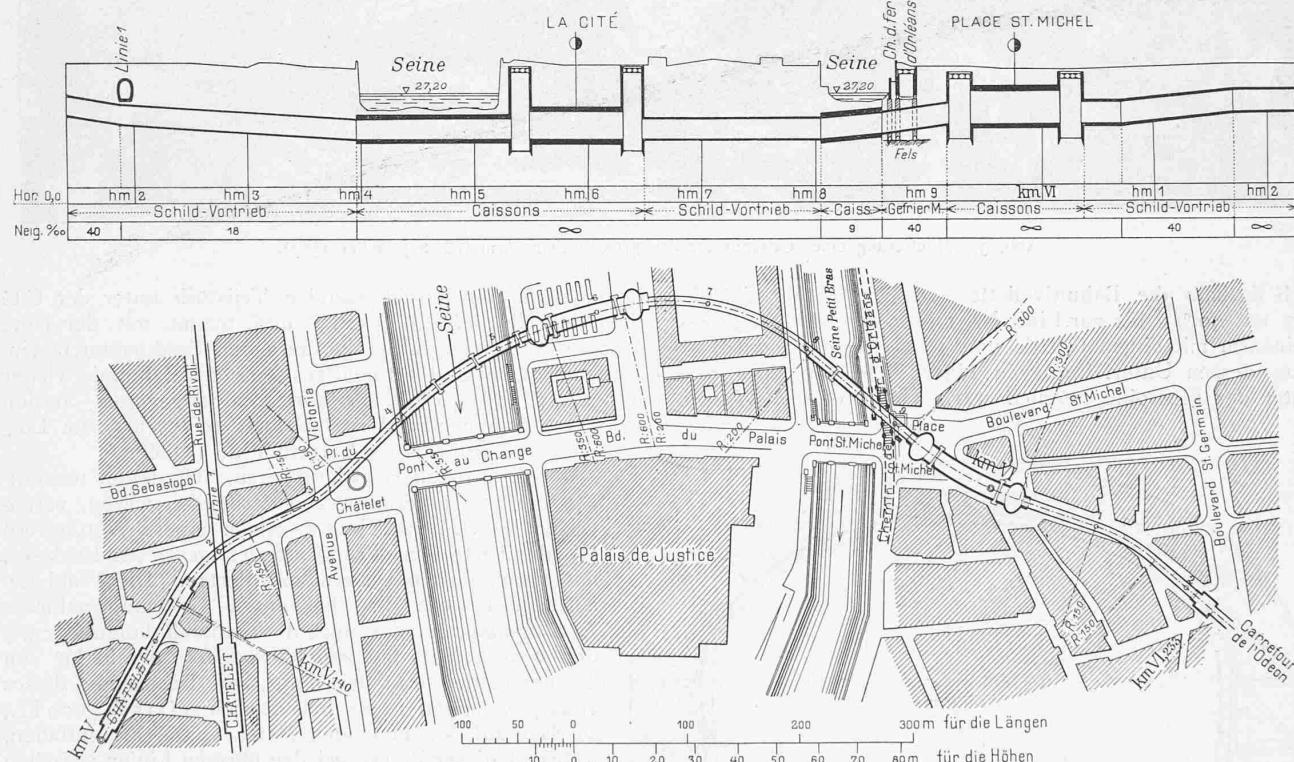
Lageplan und Längenprofil des 7. Bauloses der Pariser Stadtbahlinie Nr. 4. — Maßstab: Längen 1:6000, Höhen 1:1700.
